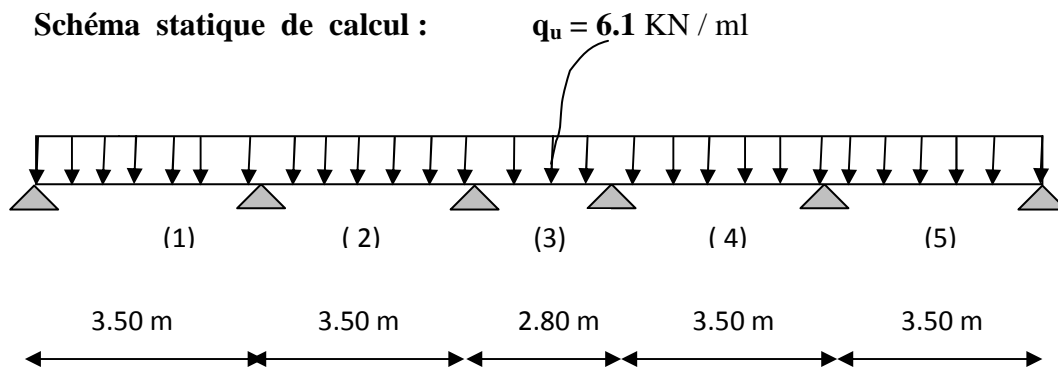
Schéma statique de la poutre continue reposant sur six appuis
